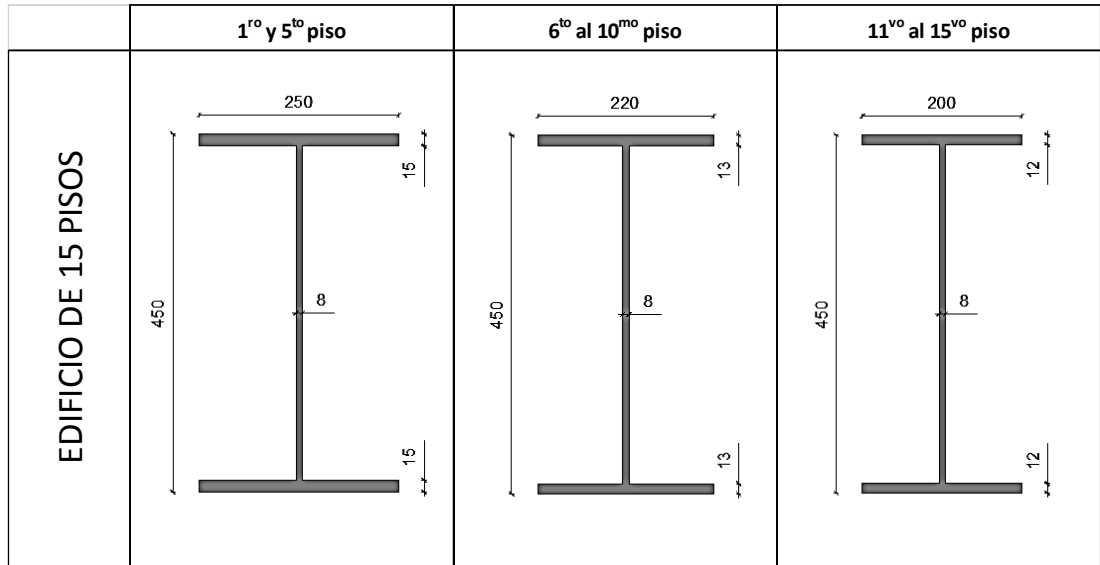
Secciones de vigas principales en edificio de 15 pisos
